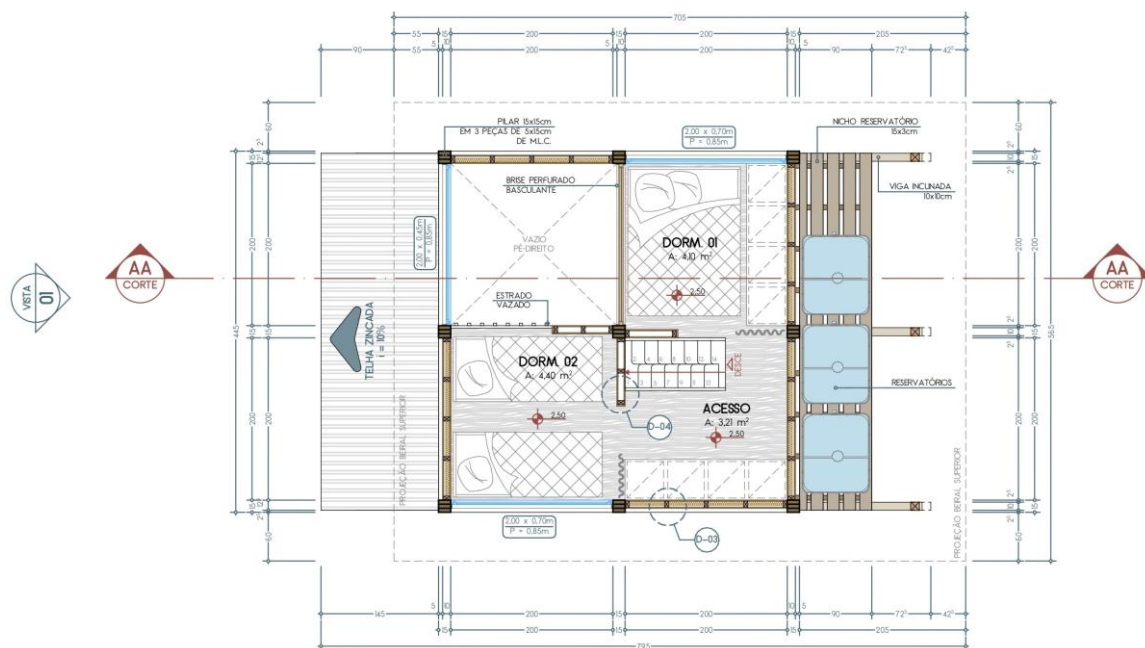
Planta baixa do mezanino. Fonte: Autores.
